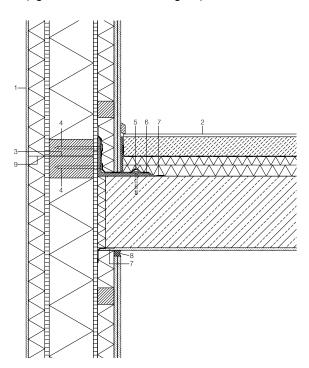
Prinzipskizze: Anschlussdetail einer vorgesetzten Fassade in Holztafelbauweise an eine Decke in Stahlbetonbauweise [11]
